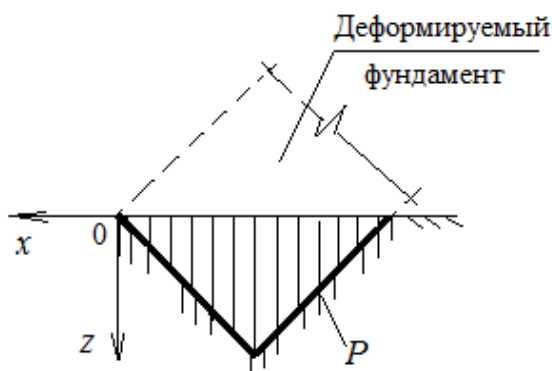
Схема от равносторонней треугольной нагрузки в основании фундамента
